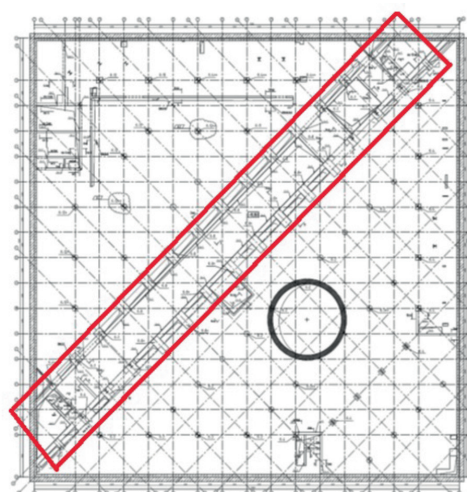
Скорректированное техническое решение проекта части конструктивной системы в зоне опирания стальных ферм на монолитные конструкции (план)
